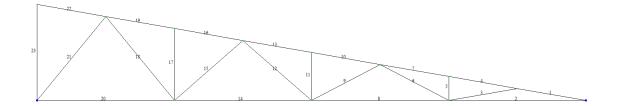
Конечные элементы стропильной фермы Ф1
